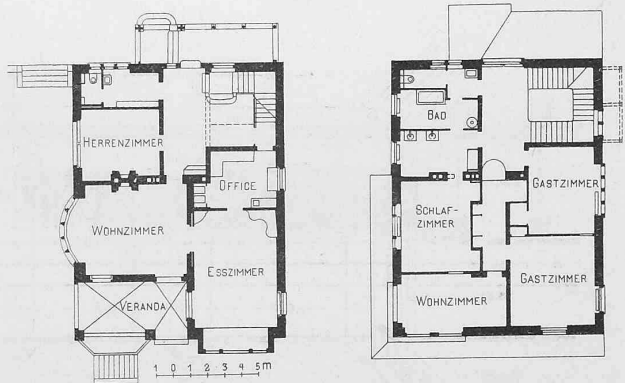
u. 5. Grundrisse vom Erdgeschoss und ersten Stock. — 1:400.
